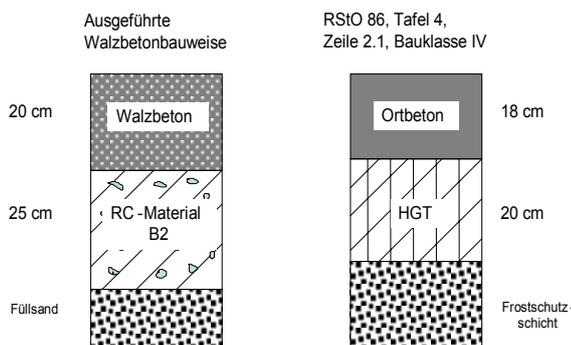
Schichtenaufbau der ausgeführten Walzbetonbauweise im Vergleich zur Bauweise nach RStO 86, Tafel 4, Zeile 2.1
